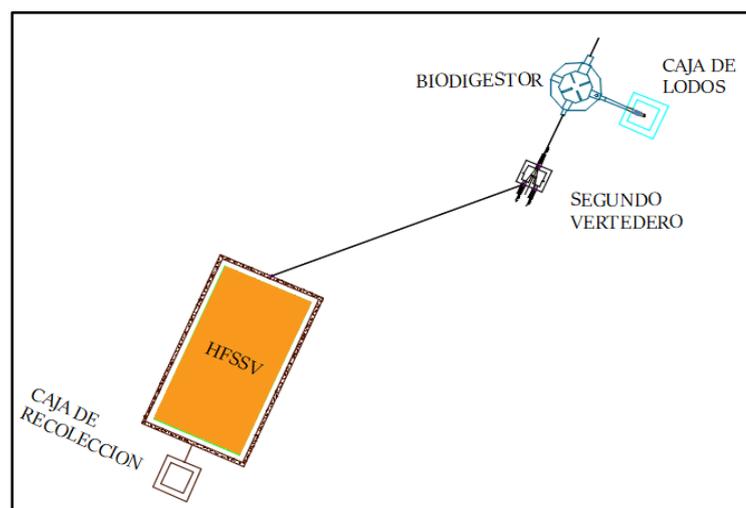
Sistema general de la planta de tratamiento. Vista en Planta.
